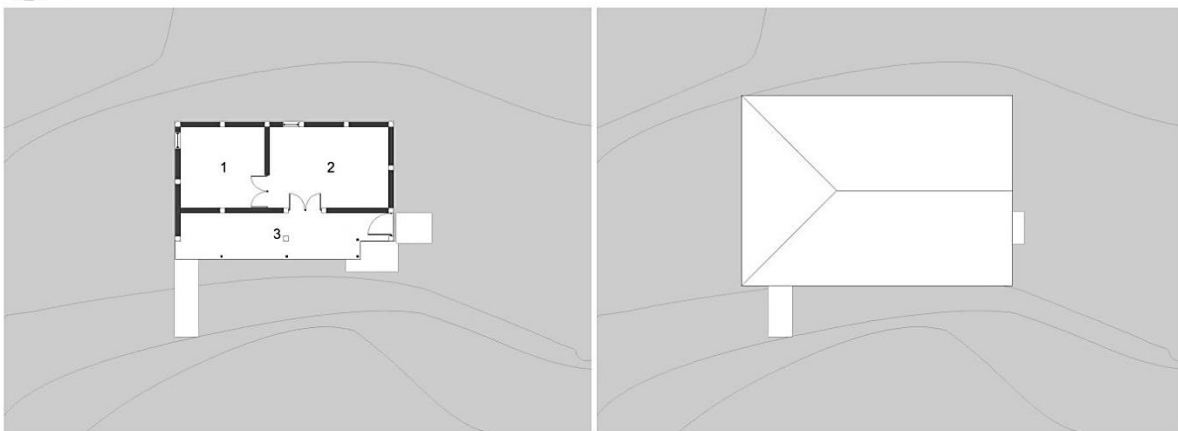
Planta Arquitectónica vivienda de bloques de concreto. Autor: Paúl Rivas Rivas.
